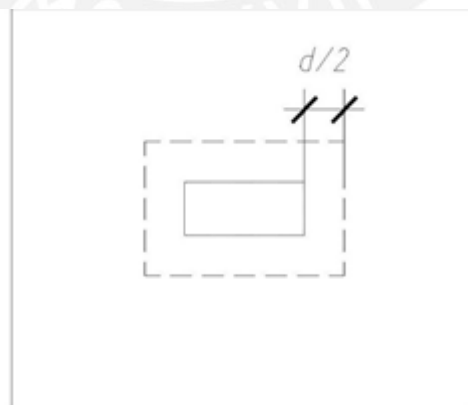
Área teórica de punzonamiento en la zapata aislada.
